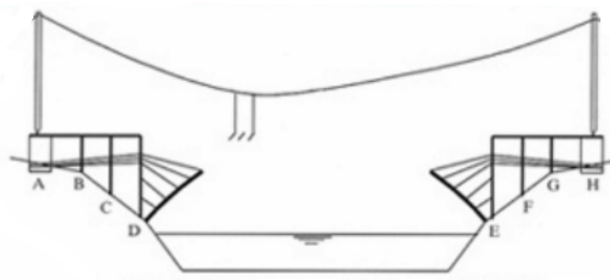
Proceso constructivo de arcos mediante cable colgado
